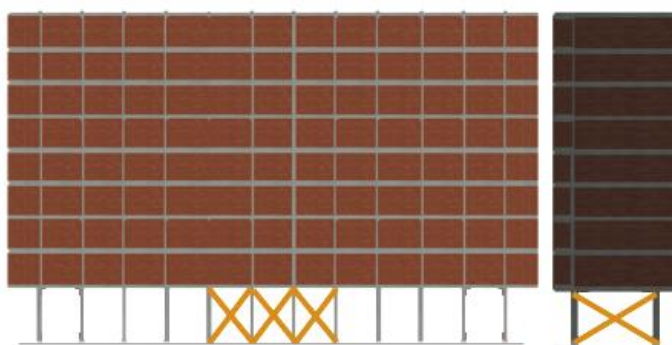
Disposição em alçado da localização dos contraventamentos metálicos.
